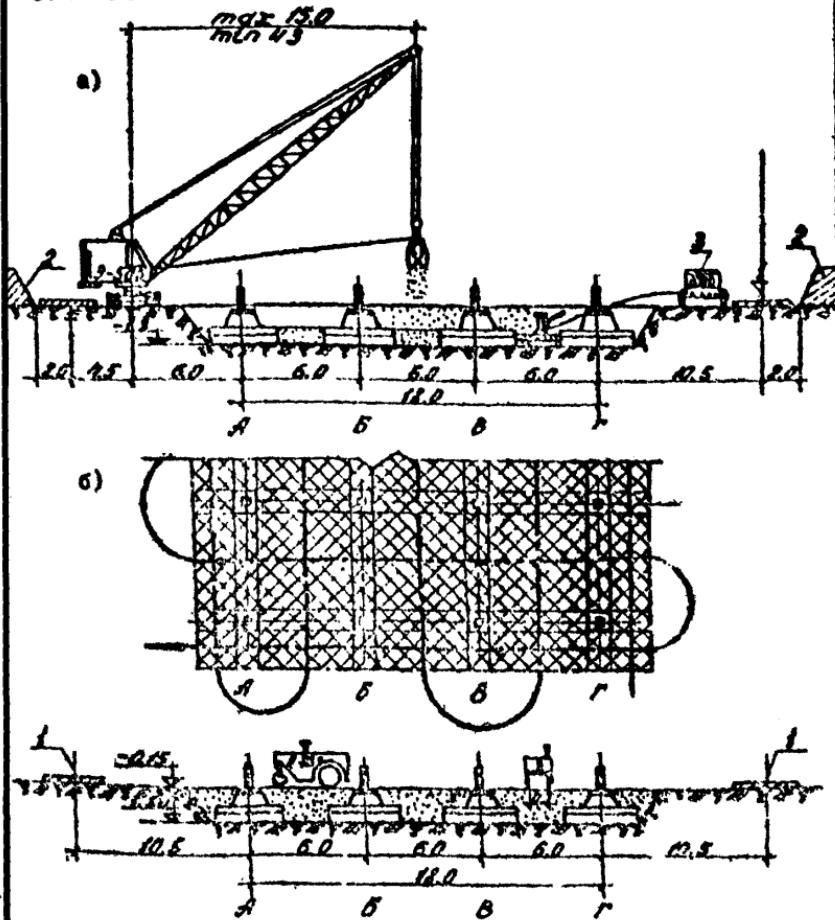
Рис. I. Схема организации работ при обратной засыпке и уплотнении грунта в котловане,
